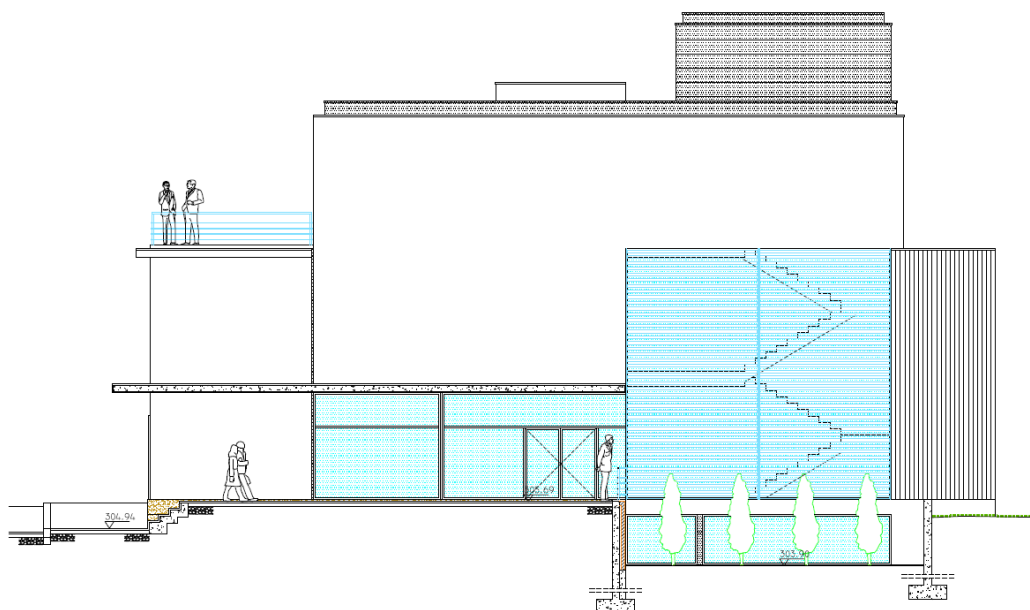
Alçado Nordeste. Fonte: Corcovado Construções.
